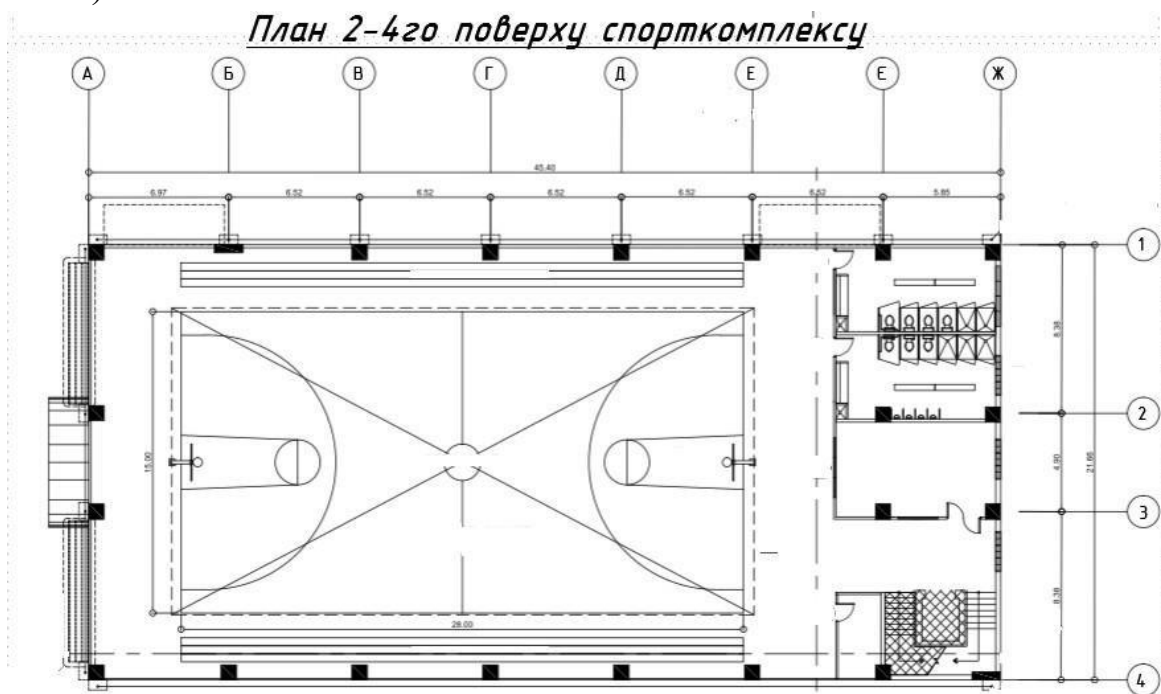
План 2-4-ого поверху Спорт-комплексу
